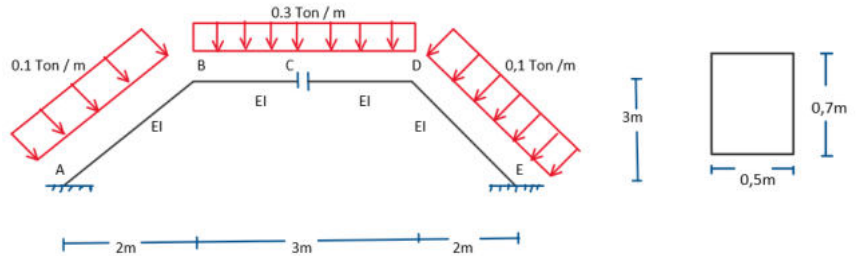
Idealización de estructura con biela interna y vigas inclinadas.
